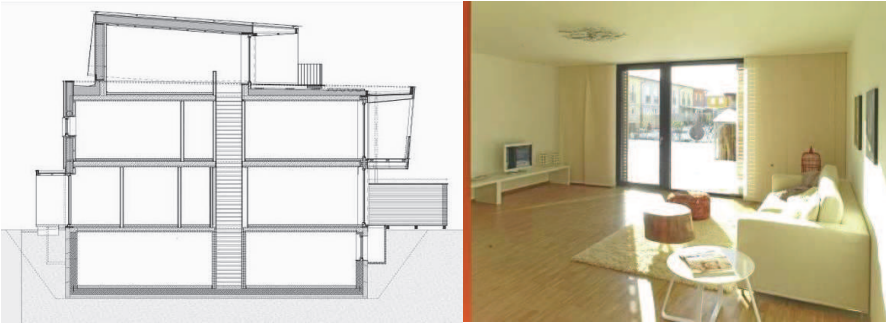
Schnitt Reihenhäuser in Poing „Zauberwinkel“ für SÜDHAUSBAU - München.
